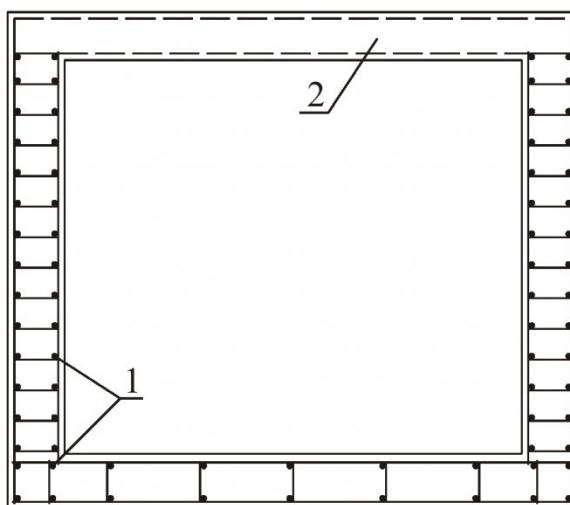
Конструкция крепи из монолитного железобетона: 1 – арматурные сетки и каркасы; 2 – двутавровая балка
